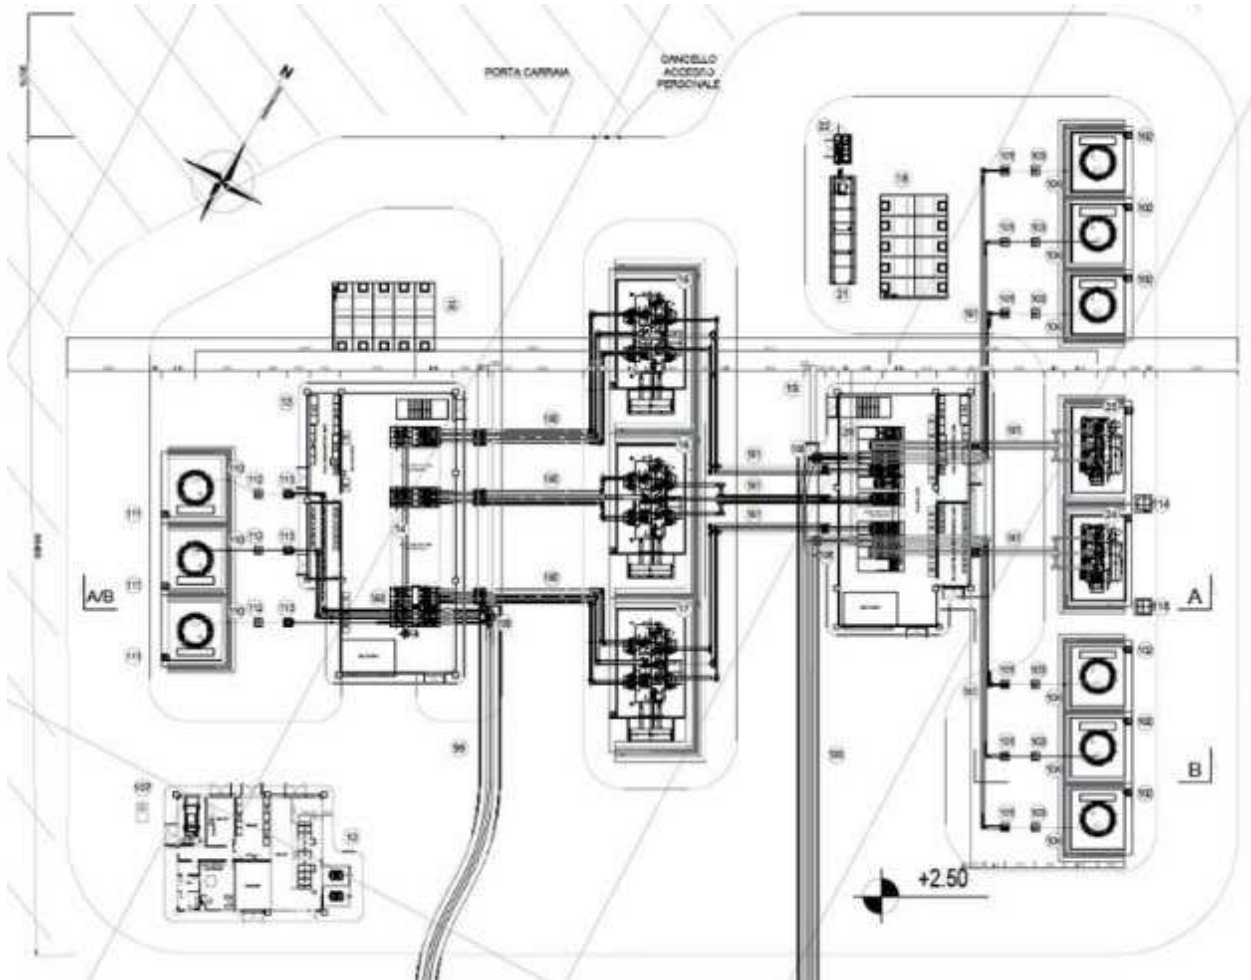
Planimetria generale della Stazione Elettrica di trasformazione 220/380kV
